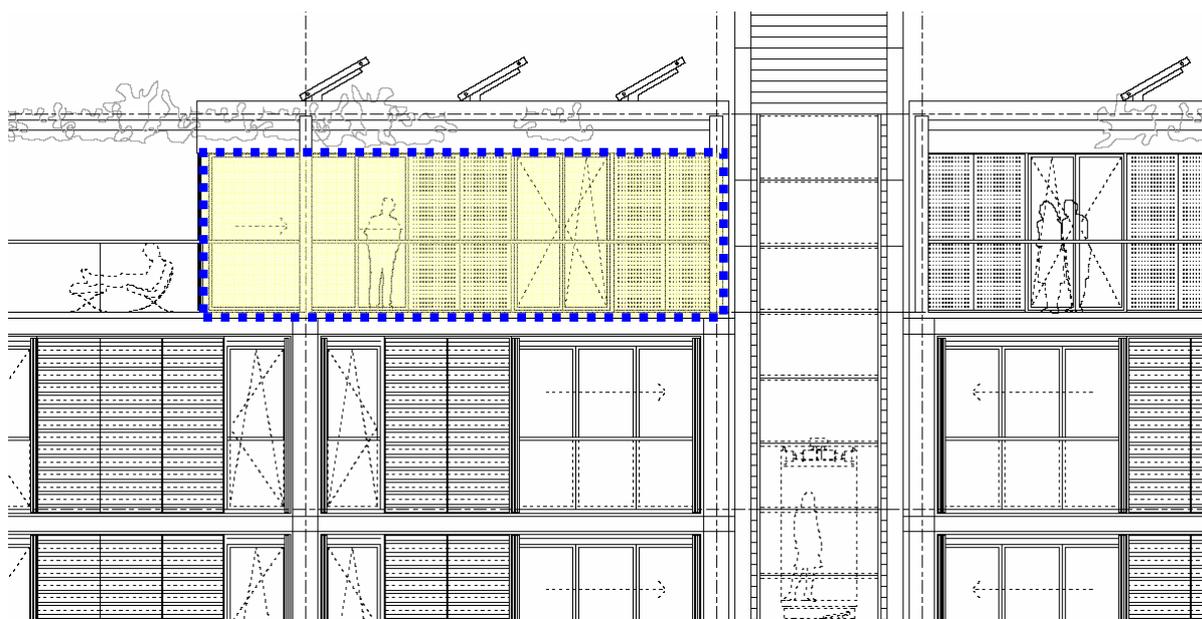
Indicazione in prospetto della facciata oggetto di valutazione
